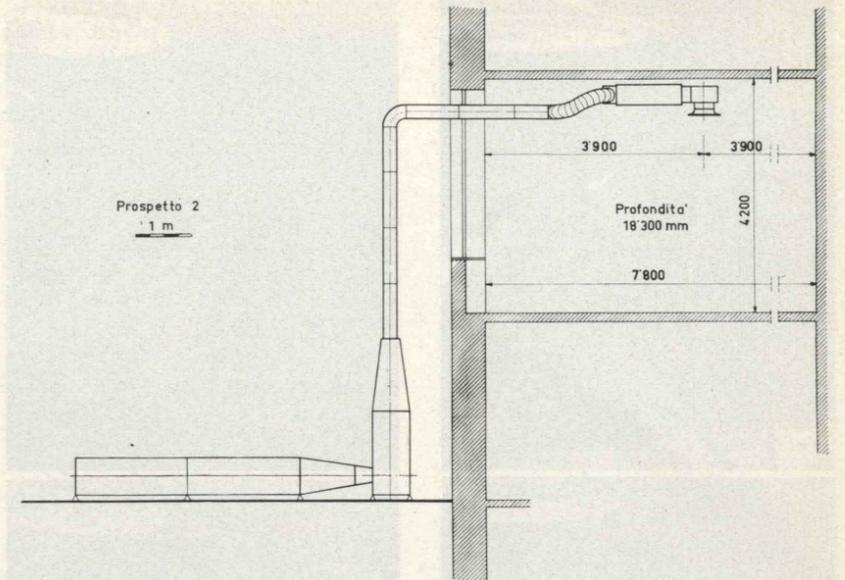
Prospetto della disposizione delle apparecchiature di prova.
